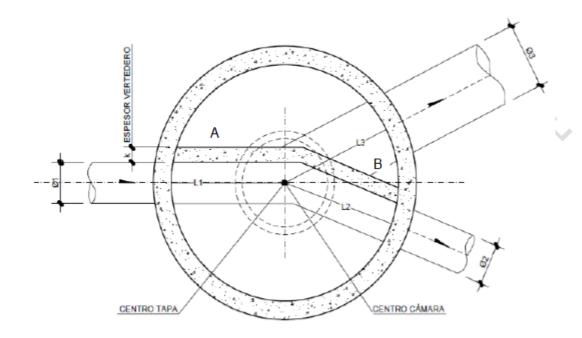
Vista planta del aliviadero trasversal con cañuela de fondo.
